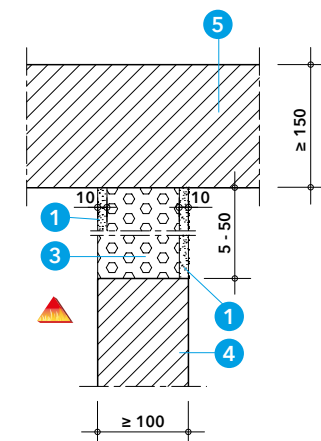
Detail I - vodorovná spára s oboustranným tmelem ve stropní konstrukci
